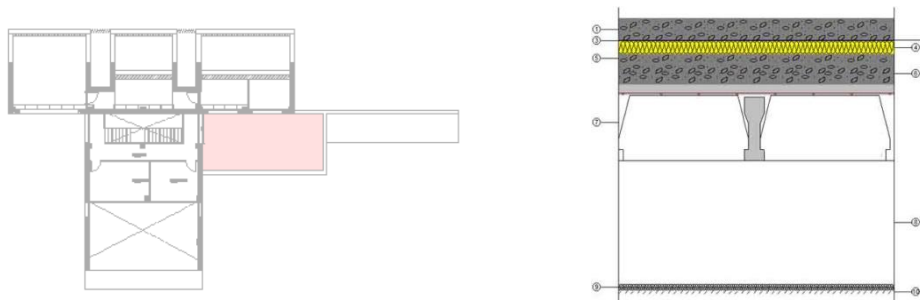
Donde se muestra donde se encuentra la cubierta plana de grava y su composición
